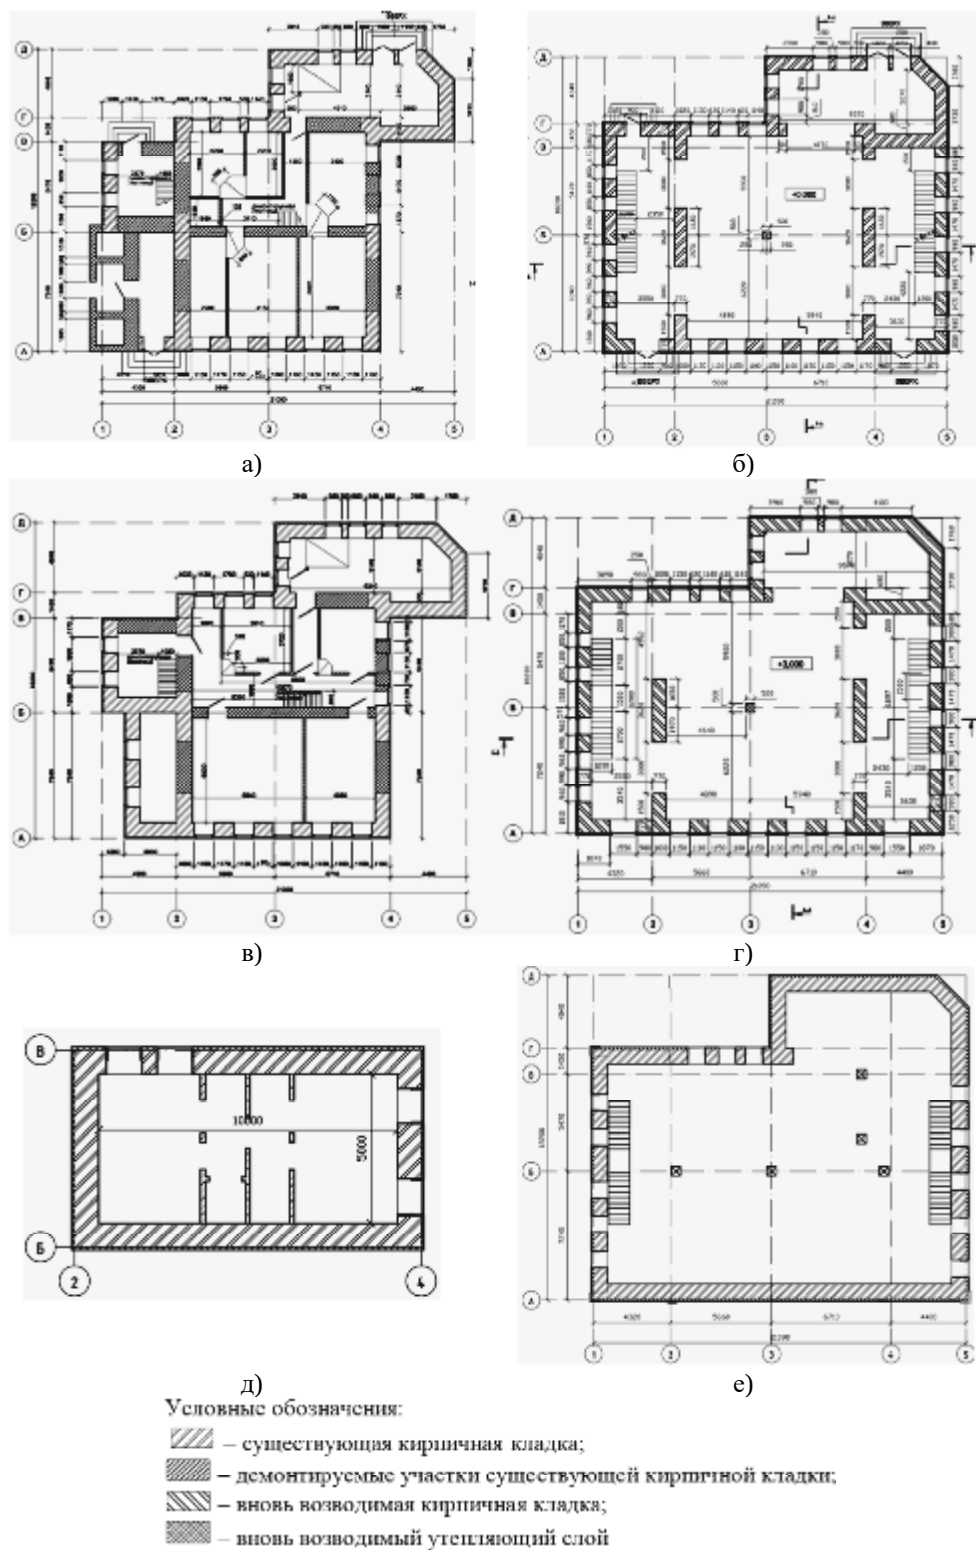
Кладочные планы первого, второго и мансардного этажей: а) 1-го этажа до реконструкции; б) то же, после реконструкции; в) 2-го этажа до реконструкции; г) то же, после реконструкции; д) мансардного этажа до реконструкции, площадью $A_{м.эт.}=50 \text{ м}^2$; е) то же, после реконструкции с перепланировкой, площадью $A_{м.эт.}=287,56 \text{ м}^2$ (иллюстрация авторов)
